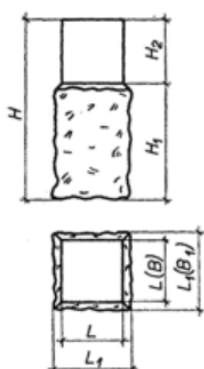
Roxor v betonovém bloku (základní odlehčená stabilizace)
